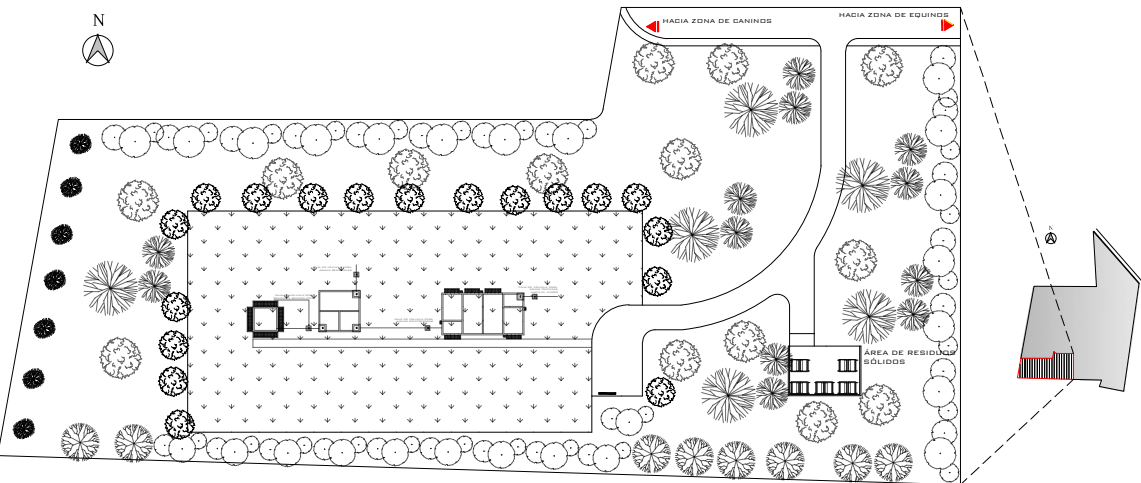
Planta de conjunto, zona de tratamiento propuesta. Fuente: Elaboración propia.
